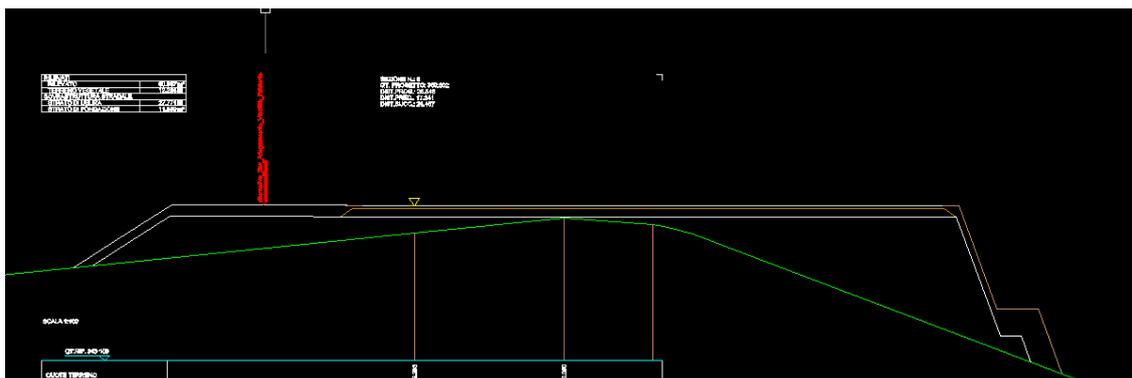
Dettaglio terre rinforzare in dx – Sez. 3 – Cantiere Base
